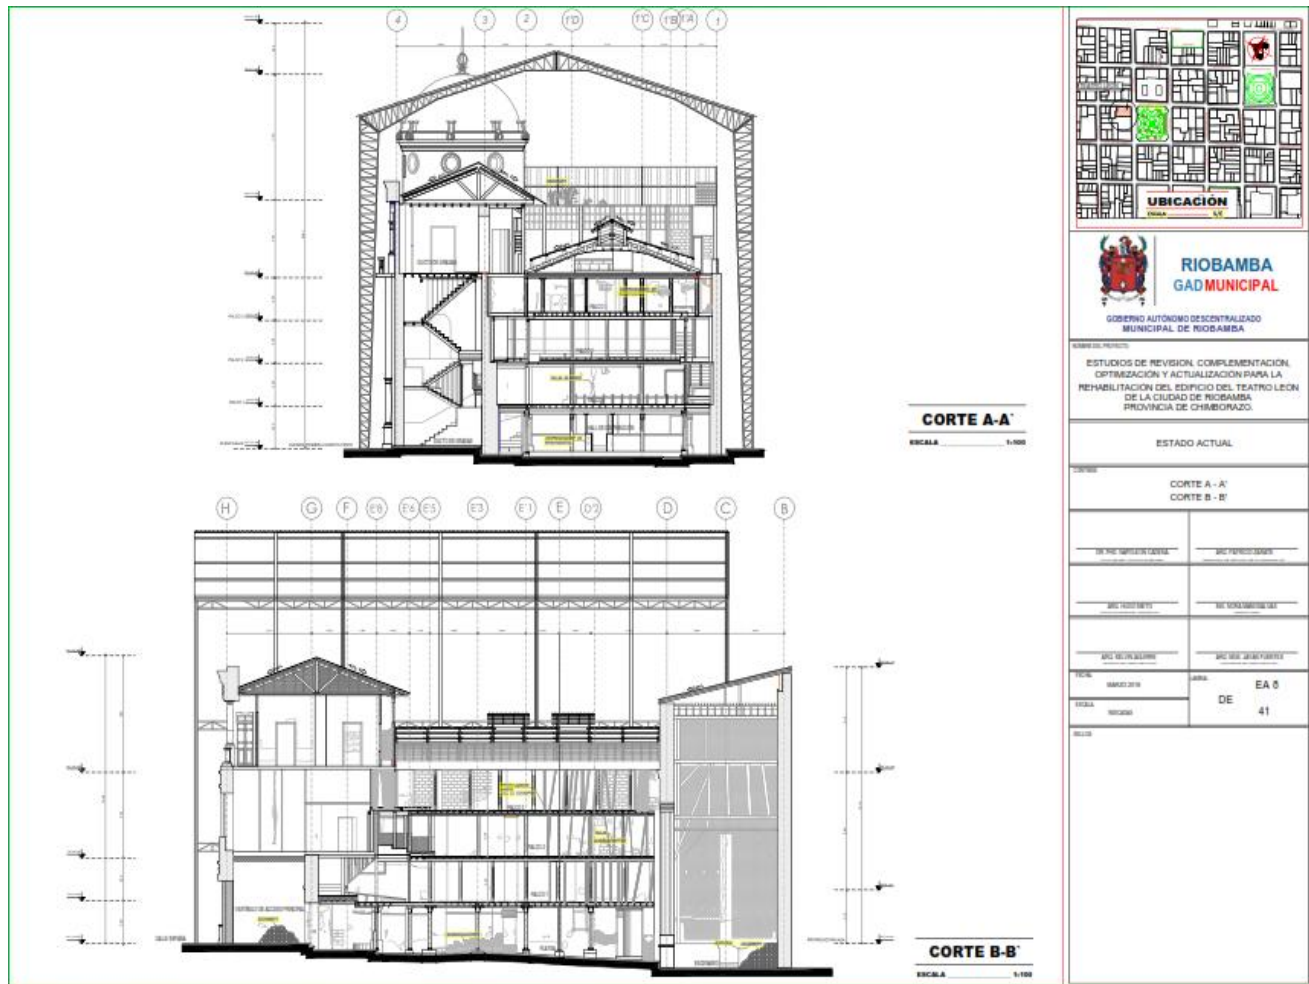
Plano realizado para la colocación de la sobrecubierta en el teatro León.
